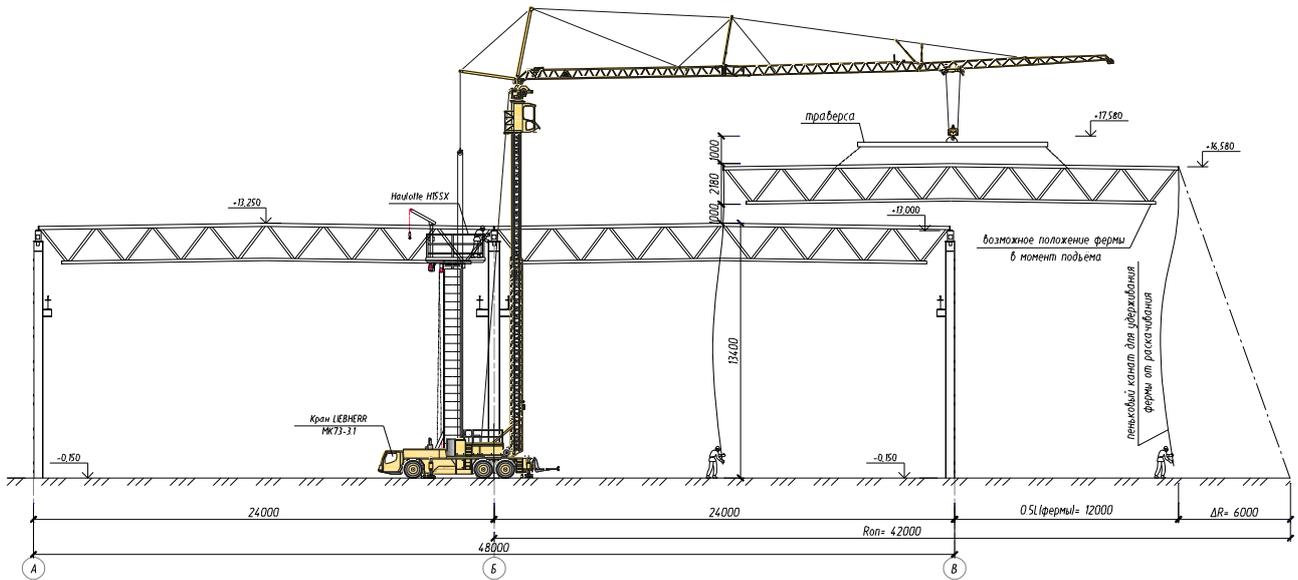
Определение границы опасной зоны при монтаже элементов покрытия
